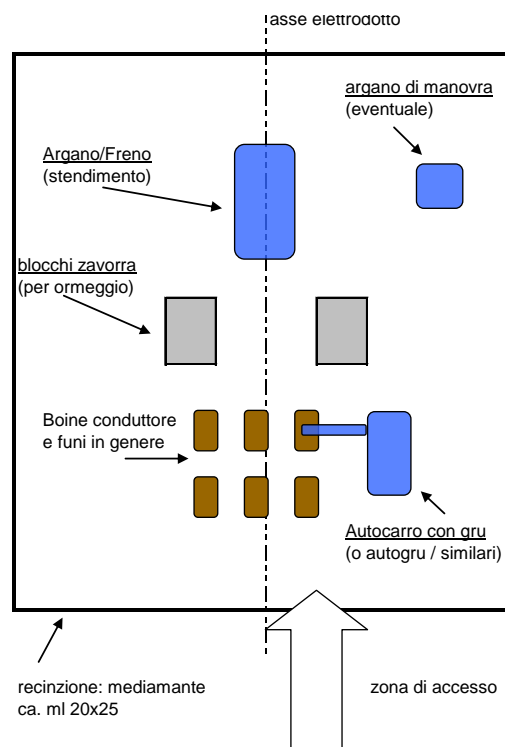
Planimetria dell'Area di linea, tipologico
